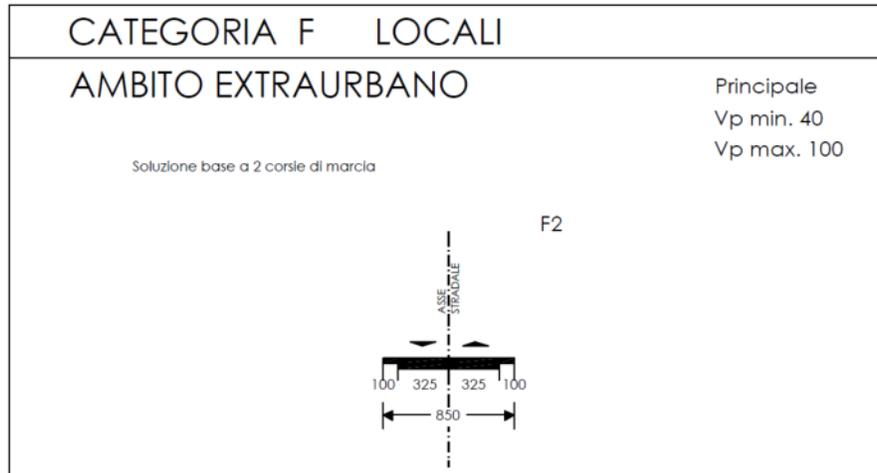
Sezione trasversale strada tipo F2 – Extraurbano
